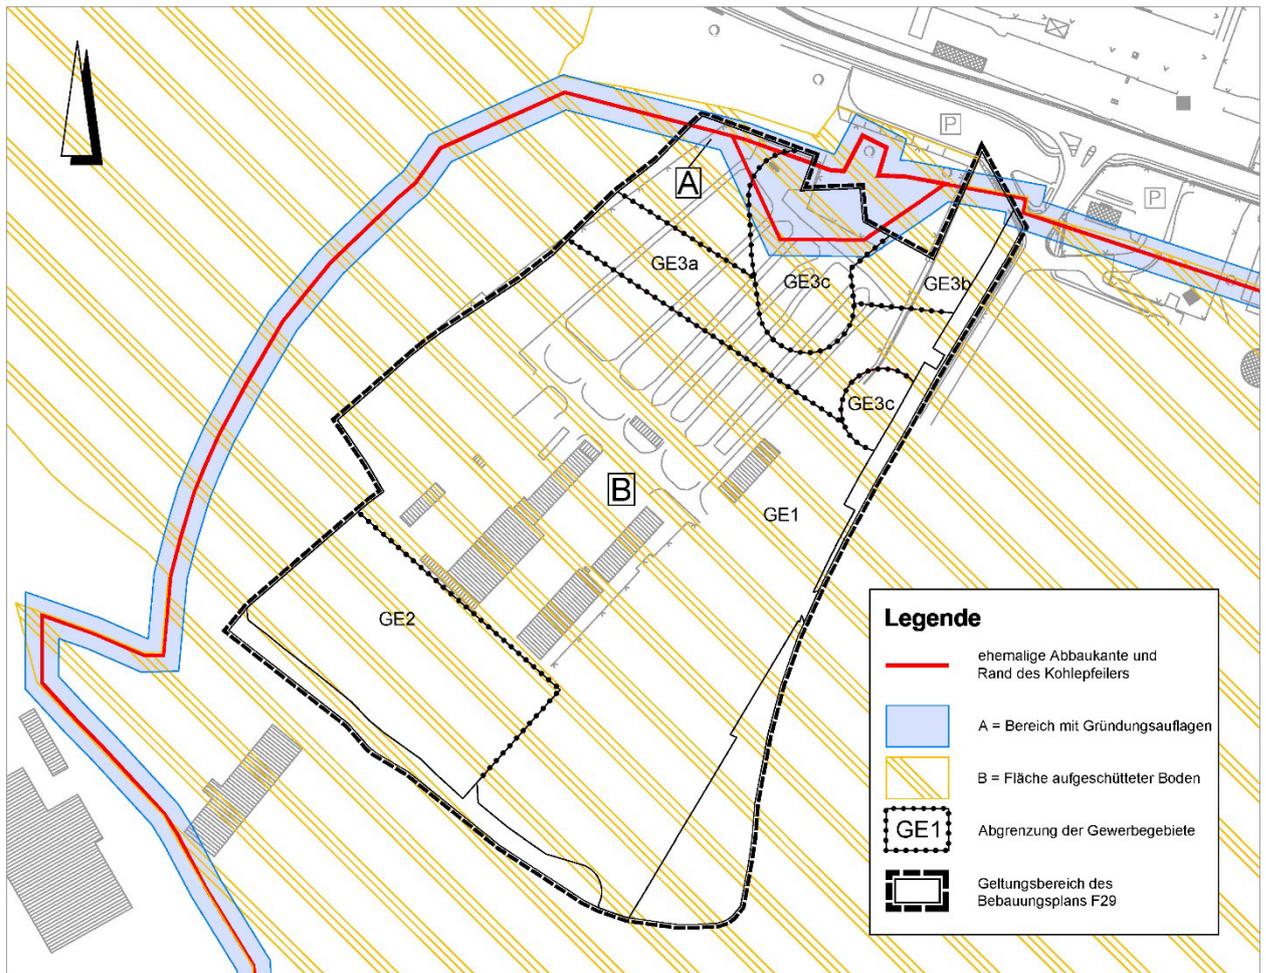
Kennzeichnungen Altbergbau und Aufschüttungen im Plangebiet.
